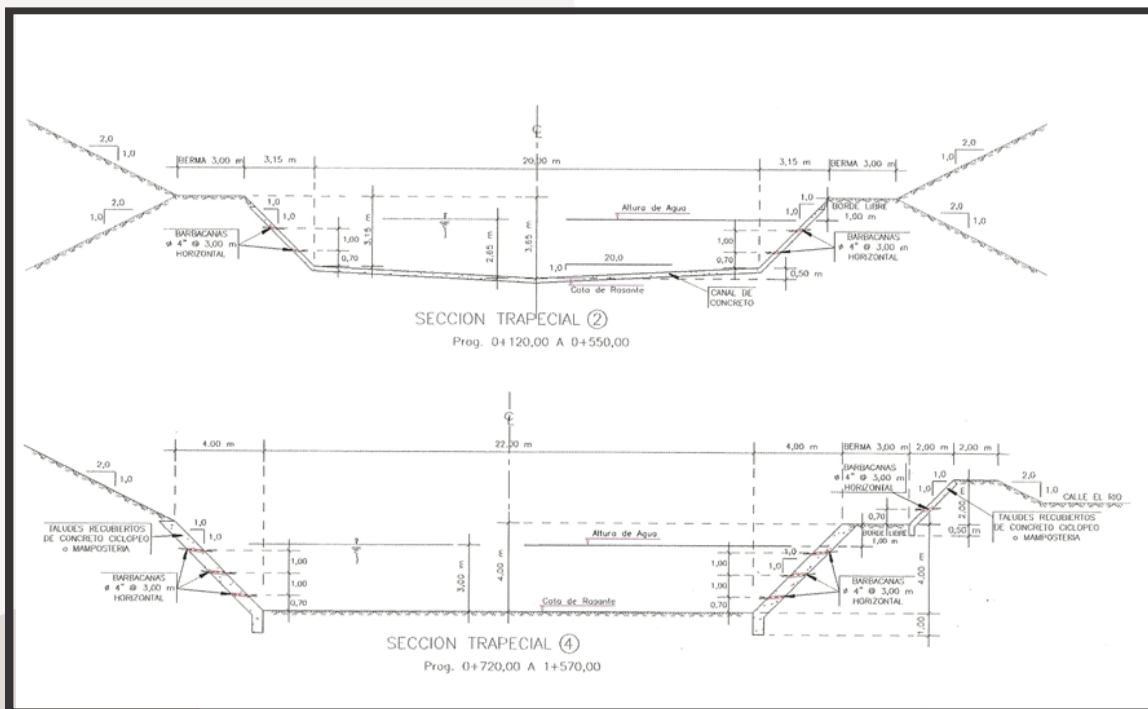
Secciones transversales de la canalización del río Naiguatá. Izquierda: Canalización en concreto. Derecha: Canalización en tierra (fondo móvil) con recubrimiento de márgenes en mampostería o concreto ciclópeo.
